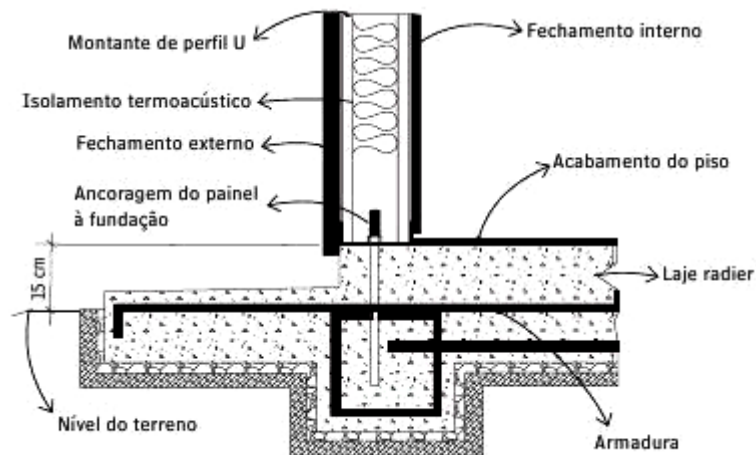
Detalhe do sistema *Light Steel Framing
